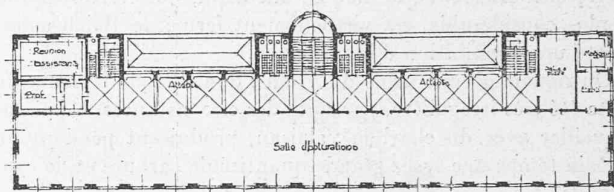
Plan du 1^{er} étage. — 1 : 800.
